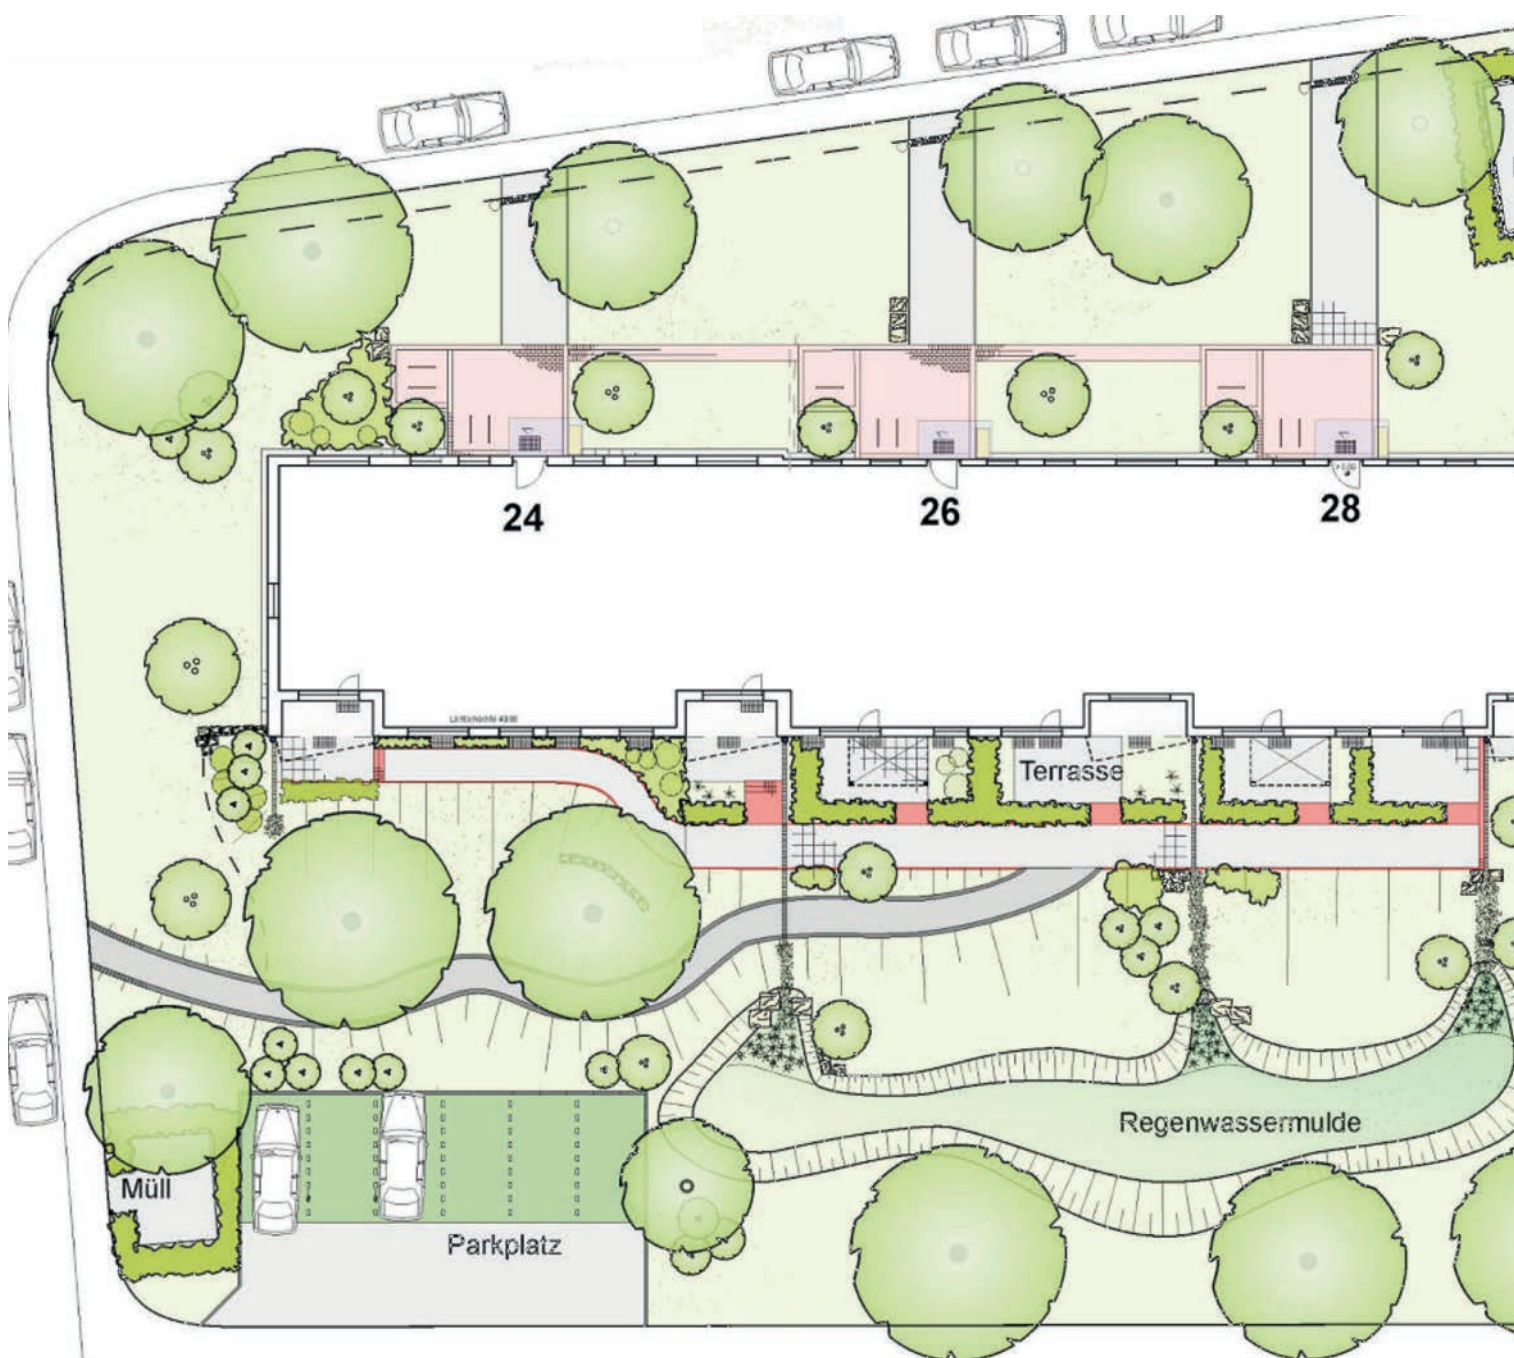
Plan zur barrierefreien Wohnumfeldgestaltung des Gebäudes Bömelburgstraße 24-28 in Hannover-Hainholz
